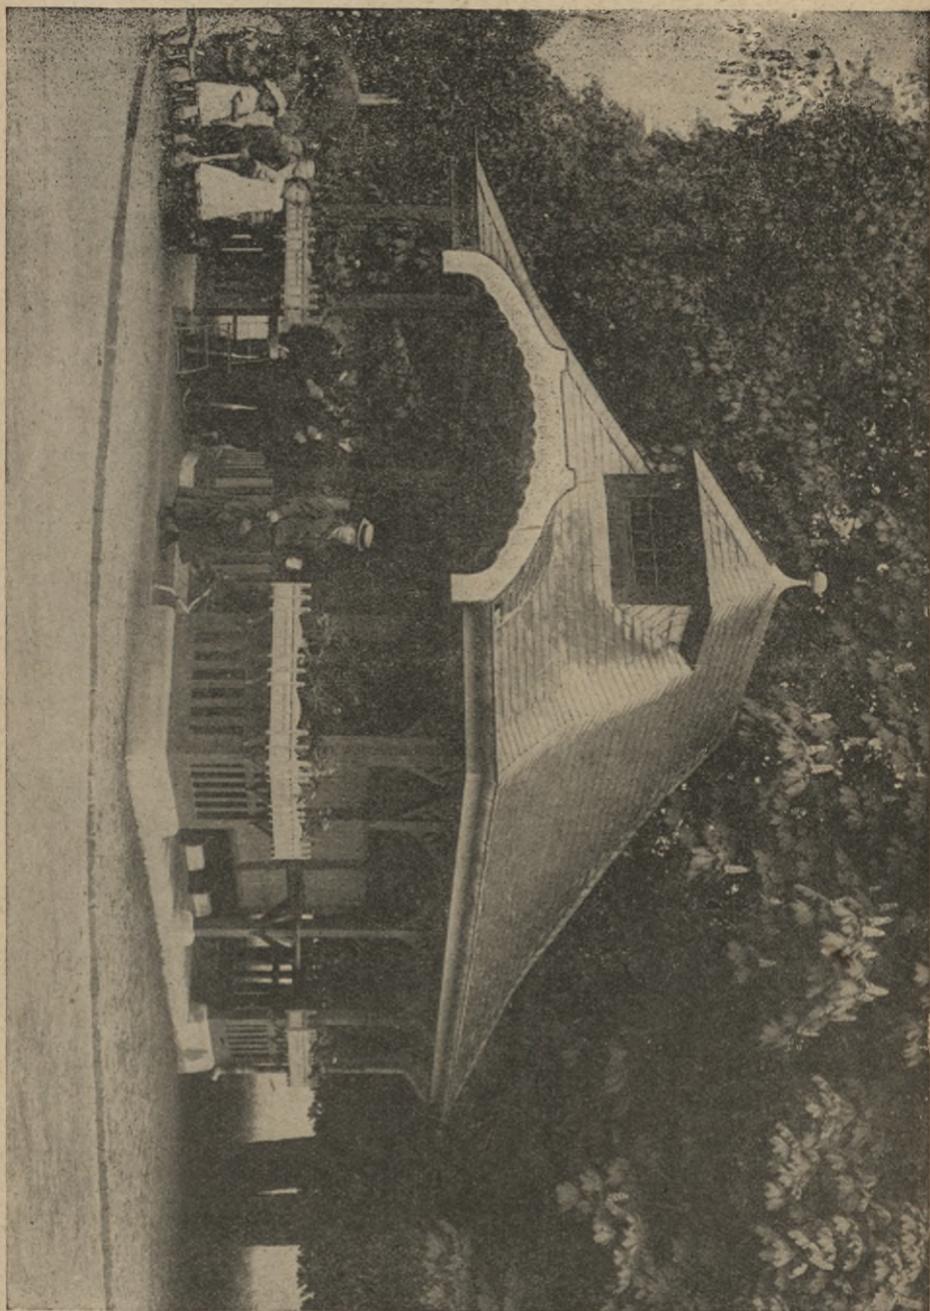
Milchtrinkhalle in Hannover mit Eisenit eingedeckt.
